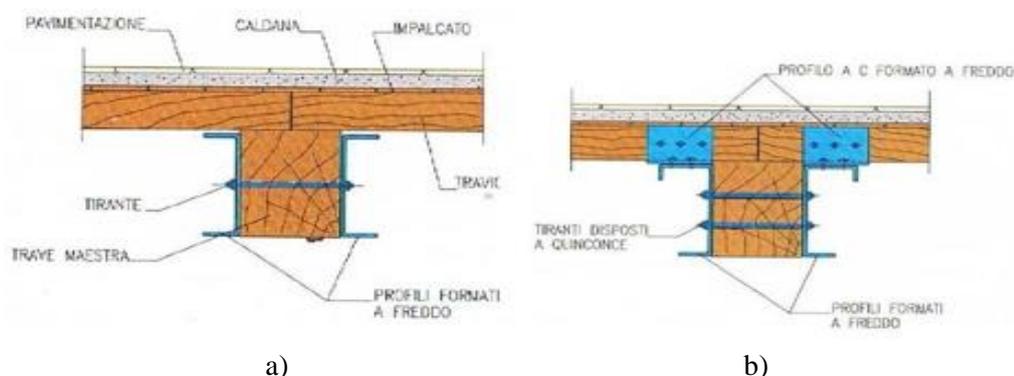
a) Reforço de viga através da colocação de perfis UNP ligados por um tirante metálico à viga existente; b) Colocação de perfis UNP ligados por dois tirantes metálicos e por duas chapas (Mazzolani, 1991)
